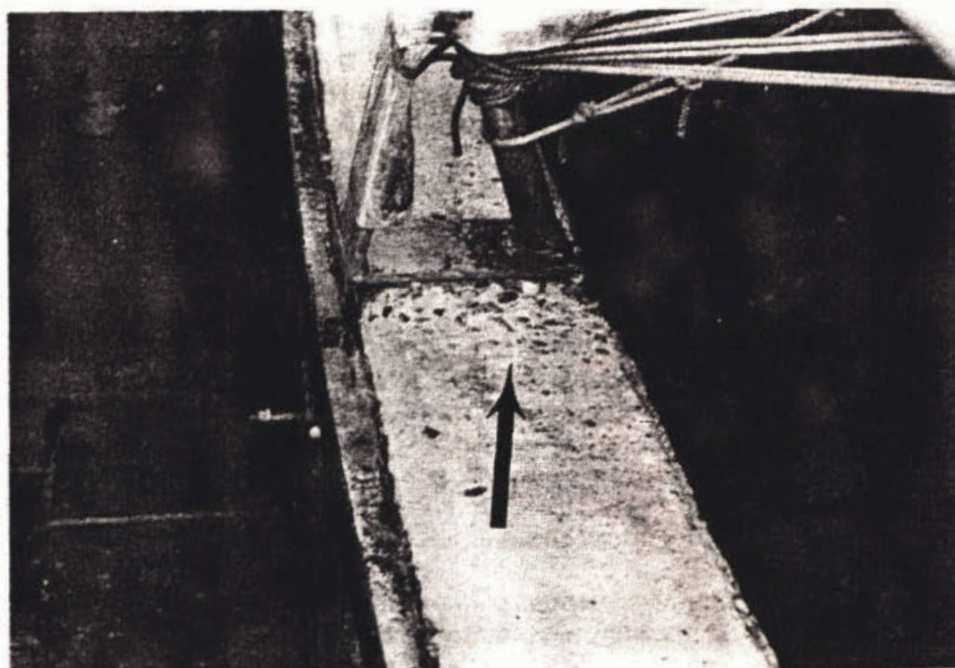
Detail bevestiging frame op betonnen wand en plaatselijke aantasting
